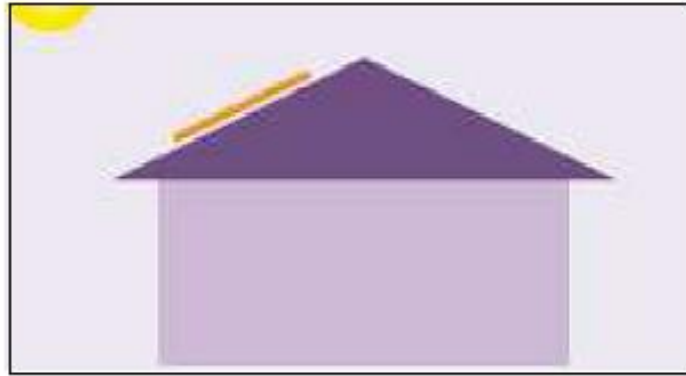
Installation du capteur sur une toiture de faible inclinaison
